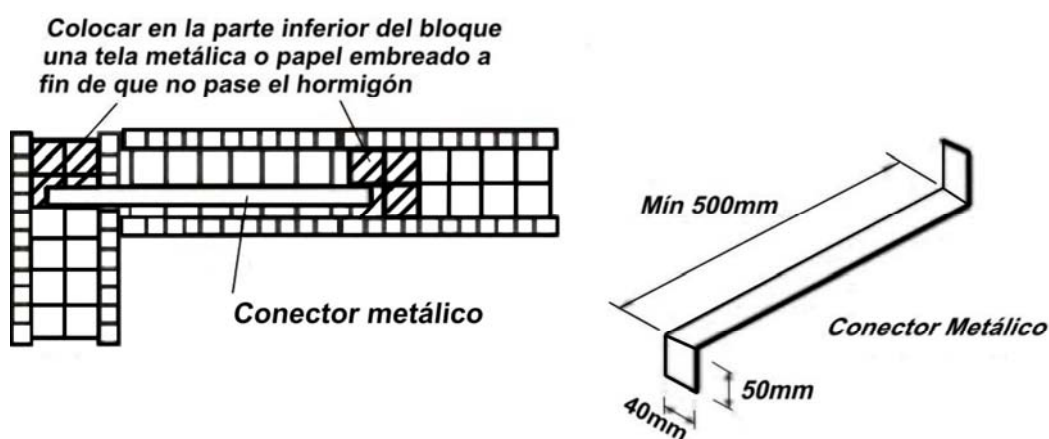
Conector metálico de anclaje en encuentro de muros.
